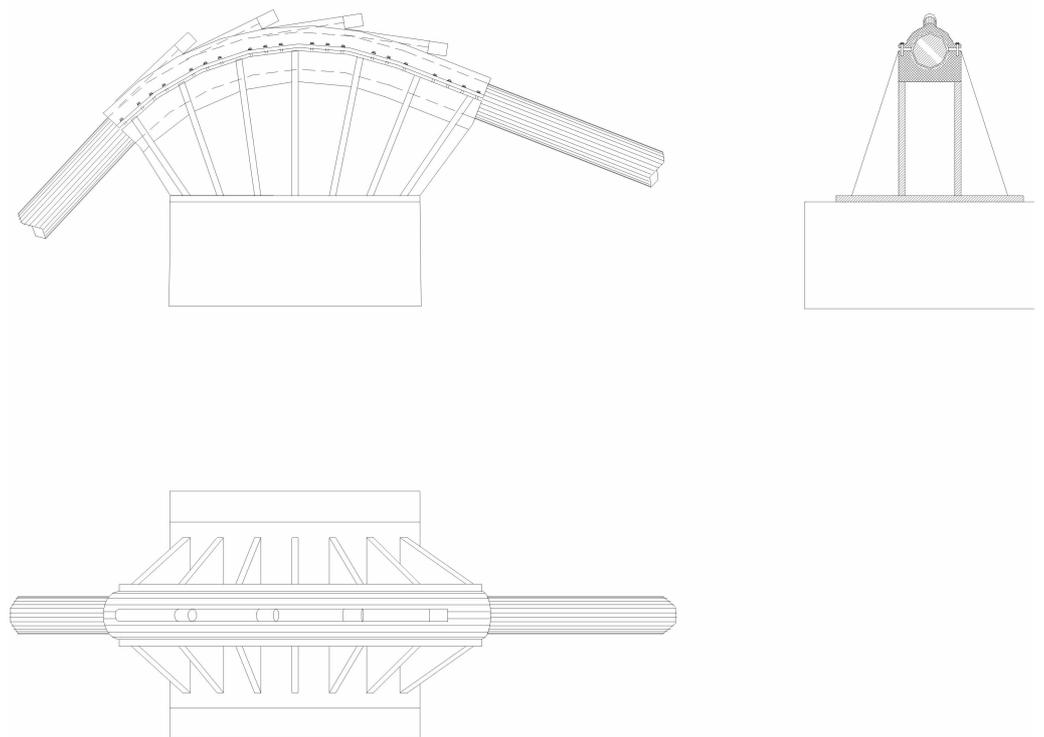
Cama de apoyo y anclaje parcial del cable principal en la cabeza de la pila.
